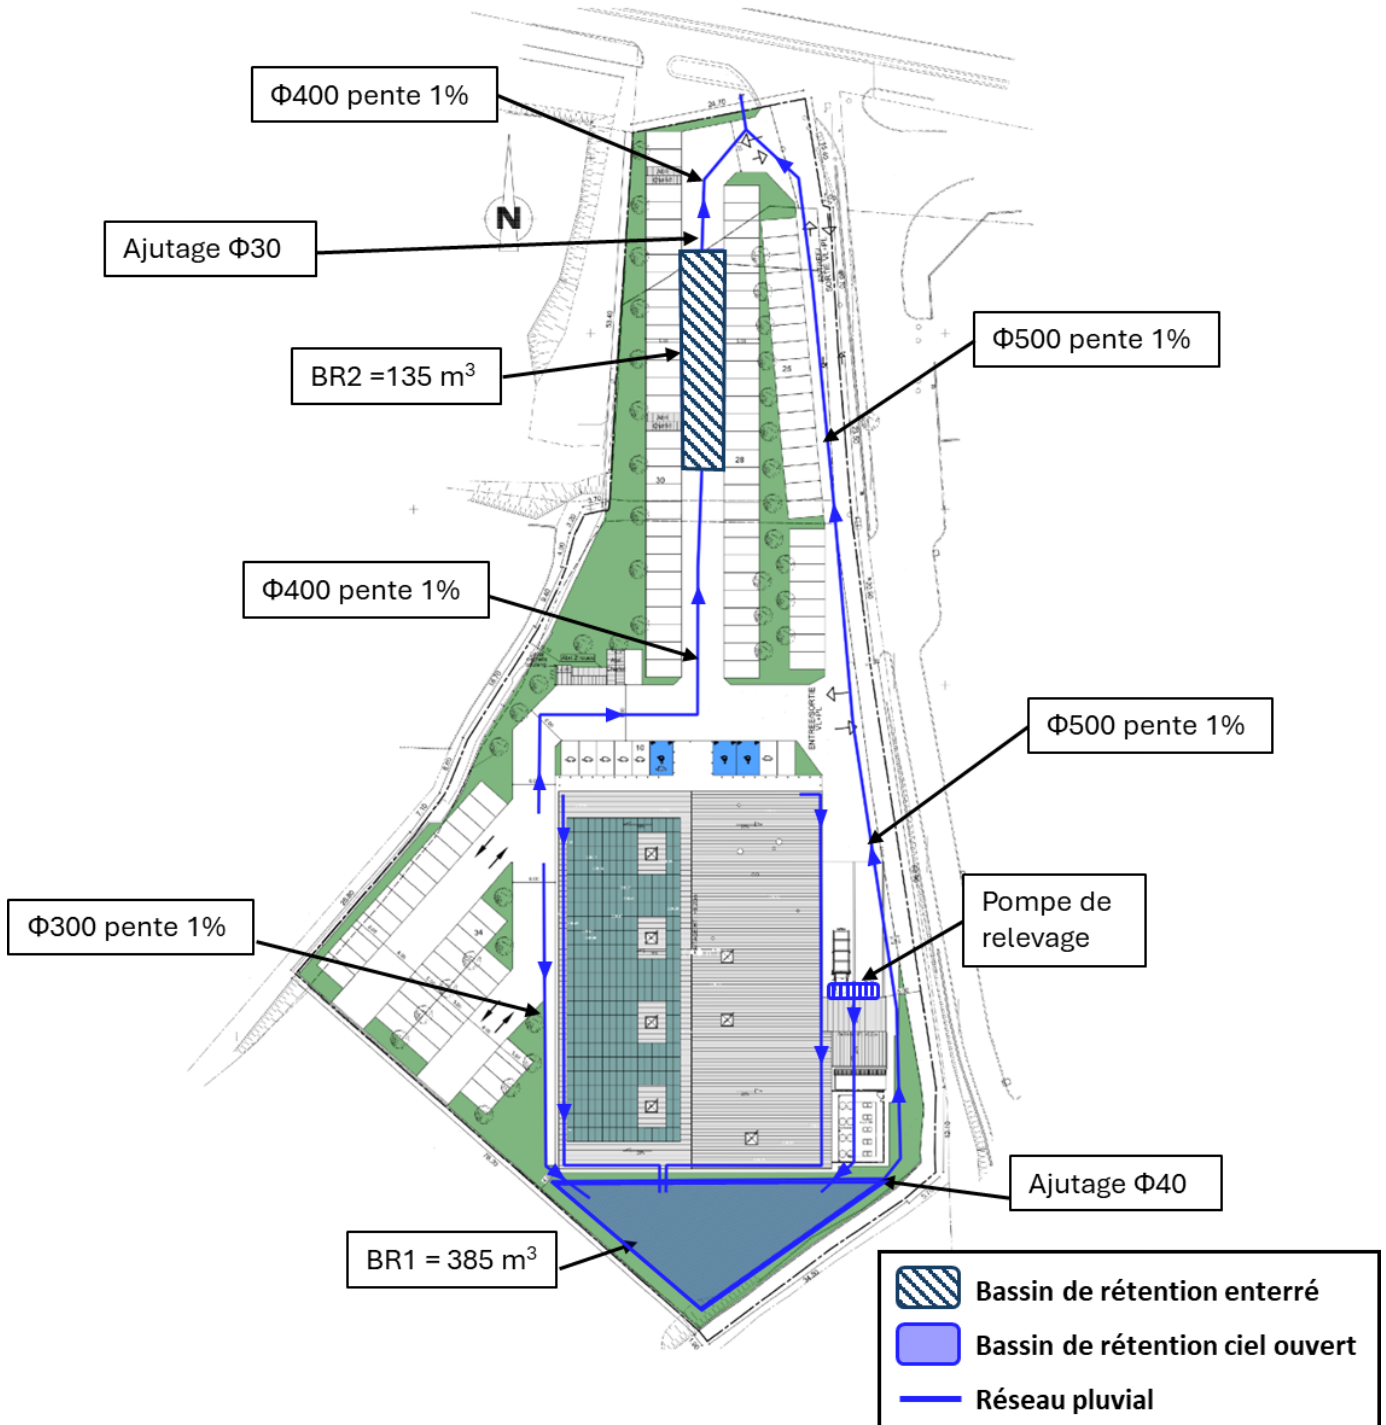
Plan d'implantation provisoire du bassin de rétention sur la parcelle du projet.
